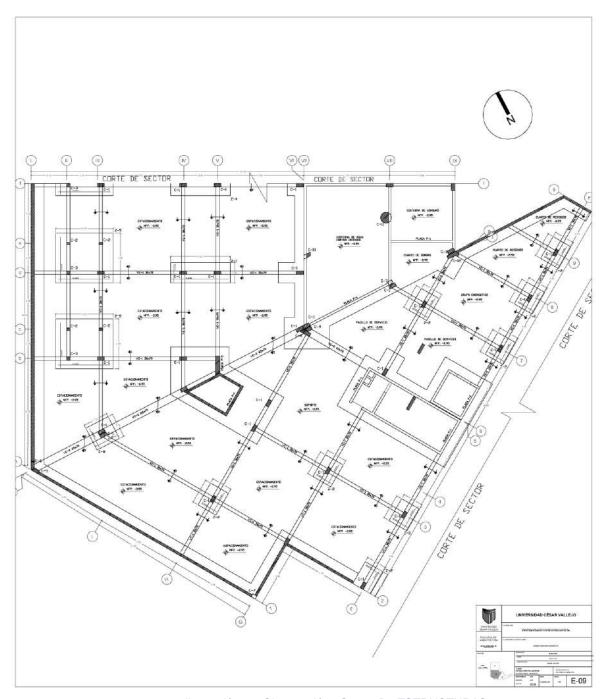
Cimentación - Sector B - ESTRUCTURAS
